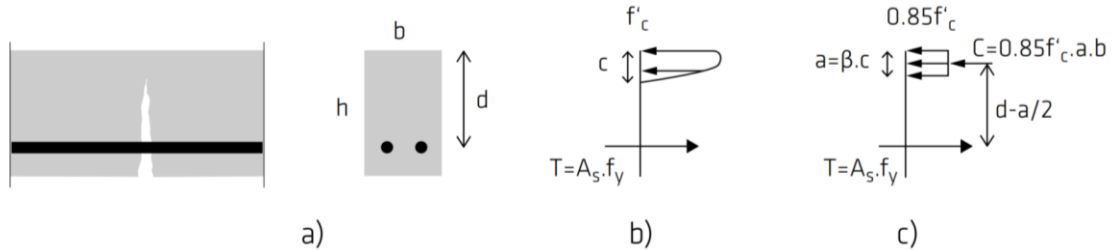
Esquema del bloque de esfuerzos en un elemento de hormigón armado fisurado en flexión sin fibras. (a) Sección de viga de hormigón armado; (b) Distribución real de esfuerzos normales; (c) Distribución simplificada de los esfuerzos normales [21].
